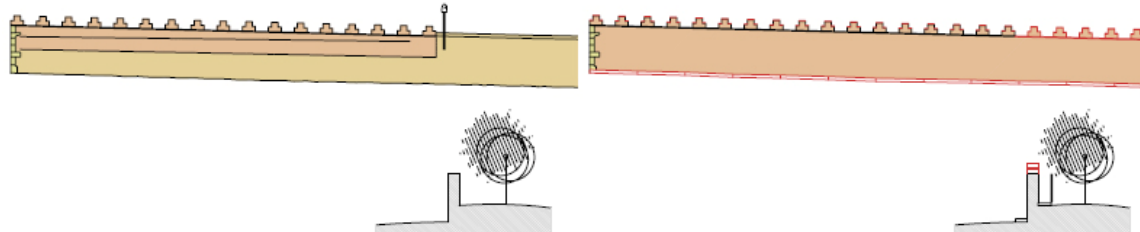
Alzado y sección del estado previo y propuesta de intervención, extraídos del proyecto.
